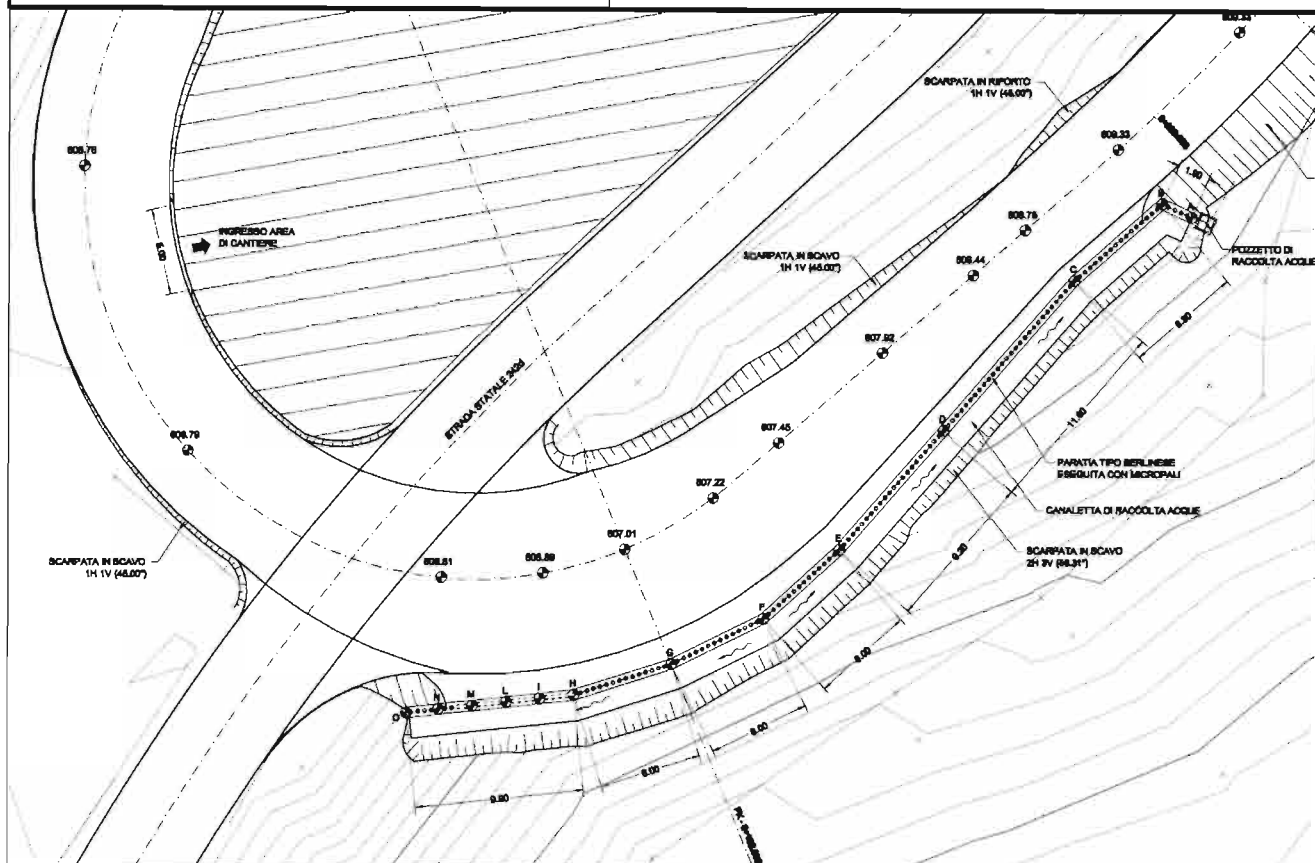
Stralcio Planimetrico delle opere di sostegno
